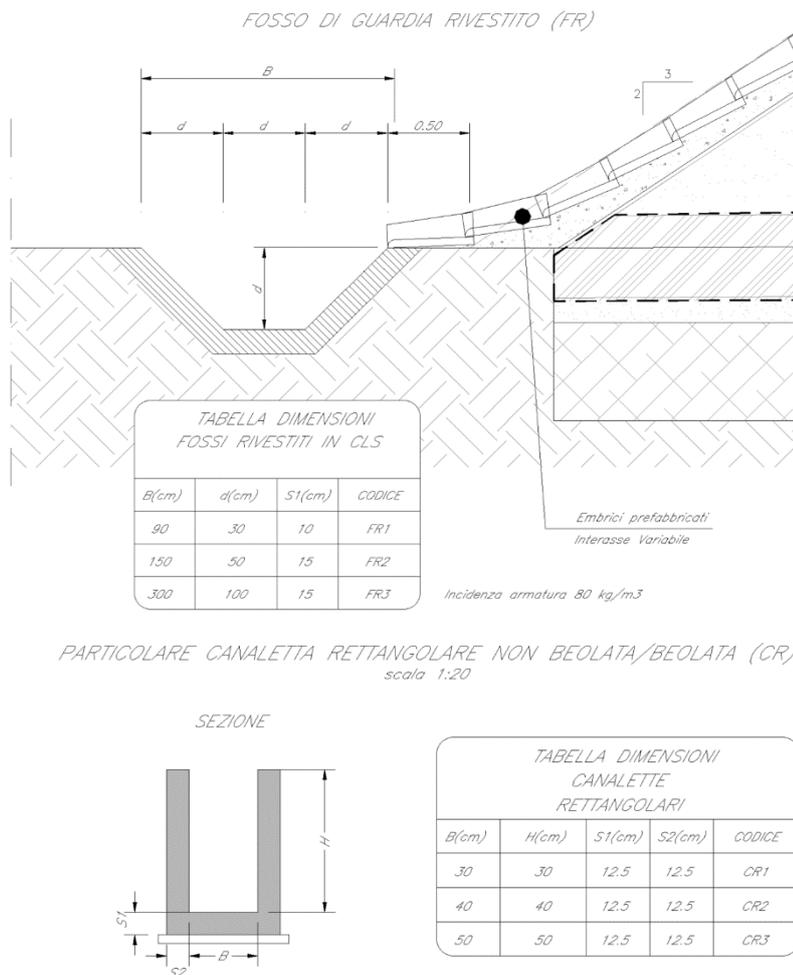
Sezione tipologica dei fossi e delle canalette in calcestruzzo utilizzati per realizzare la rete di drenaggio.
